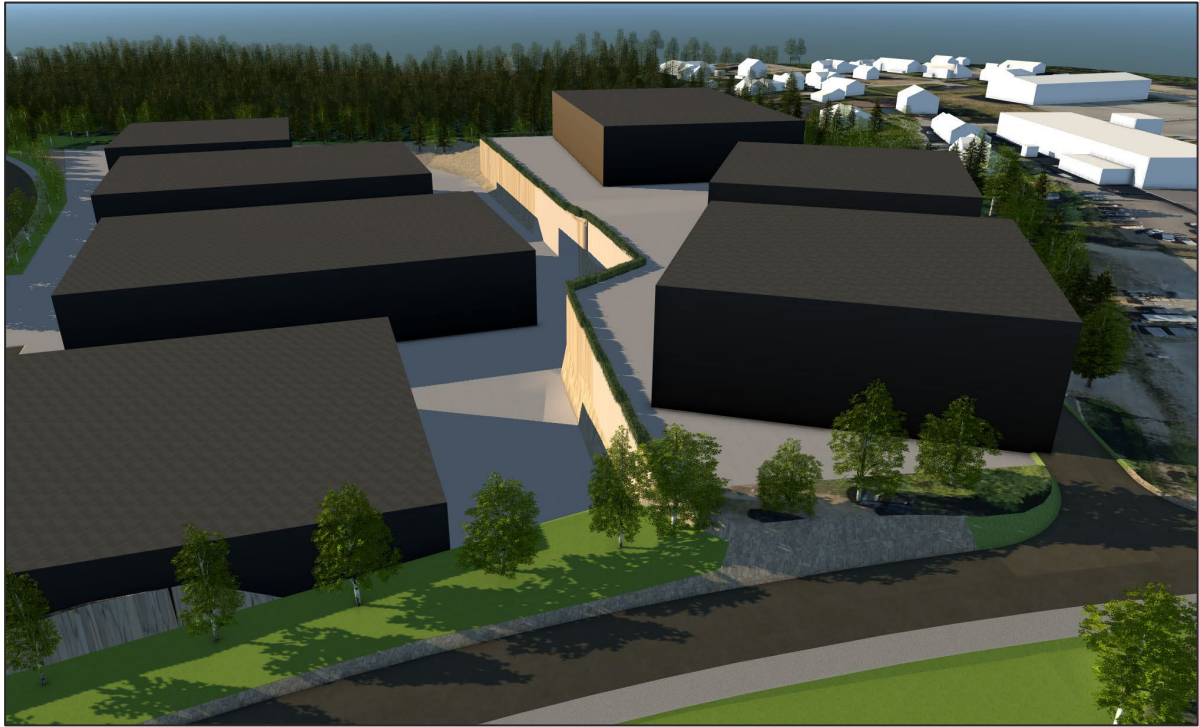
Perspektiv 9. Ved nytt kryss inn til planområdet.
